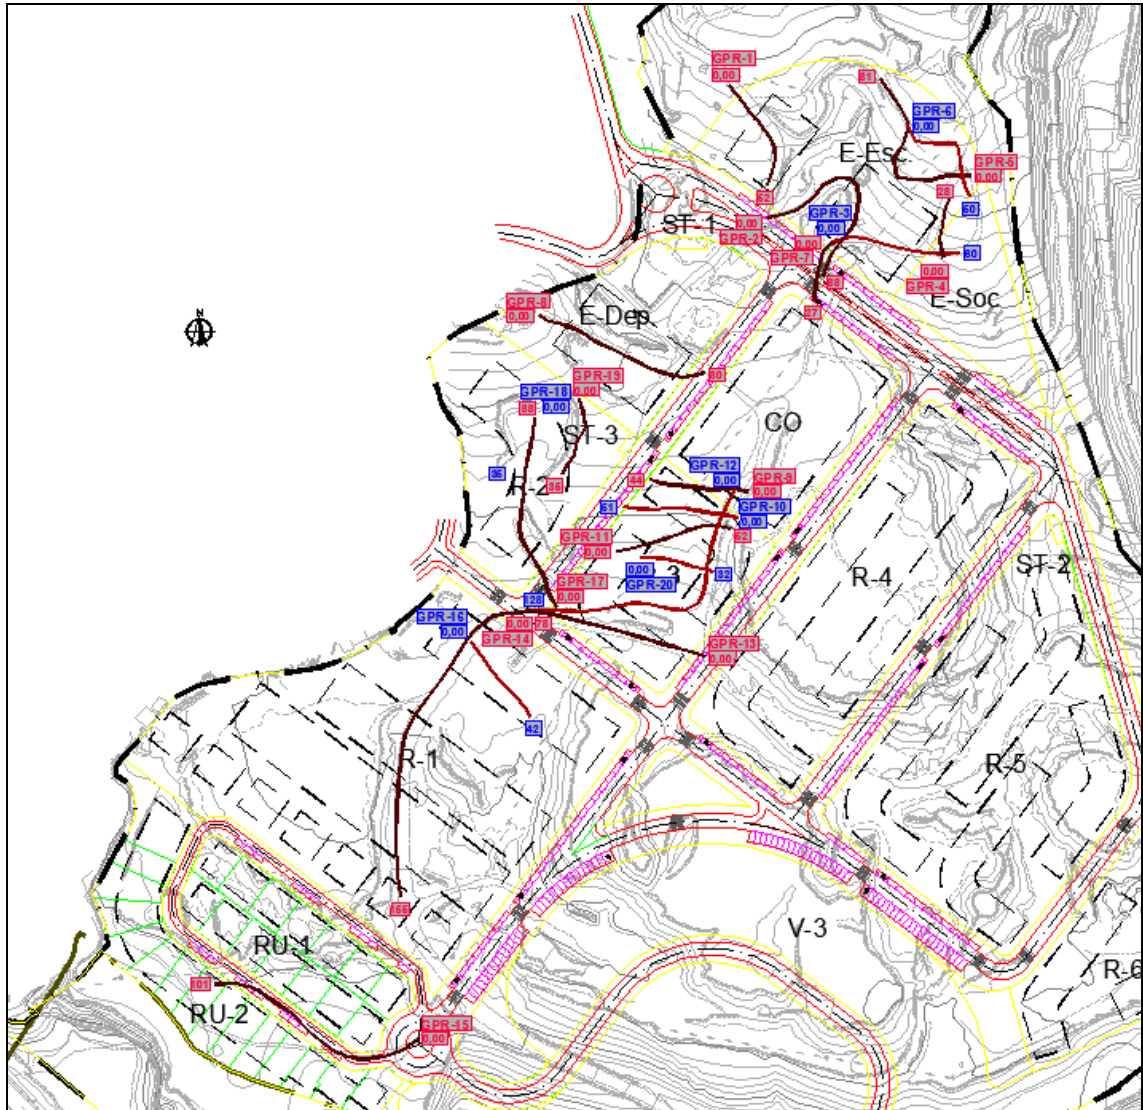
Plano de planta de ubicación de prospecciones (Georadar).
